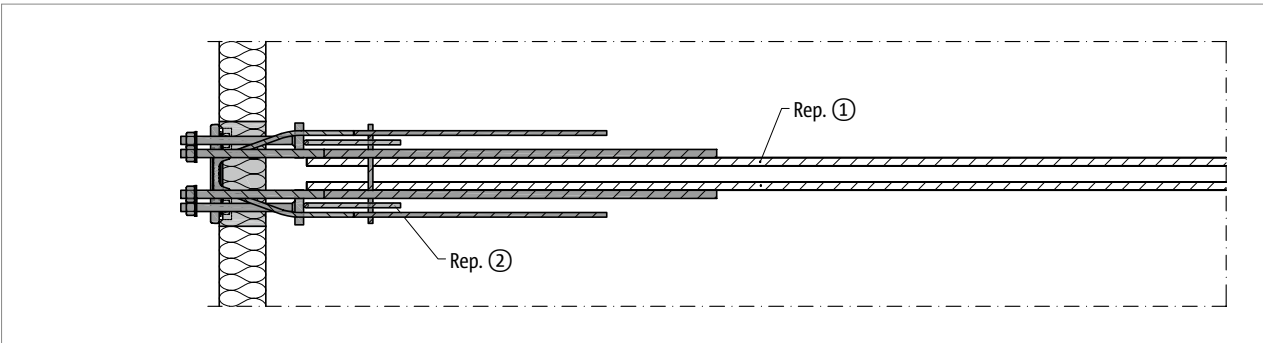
Schöck Isokorb® T type SK-M1 : armatures à prévoir par le client, vue en plan
